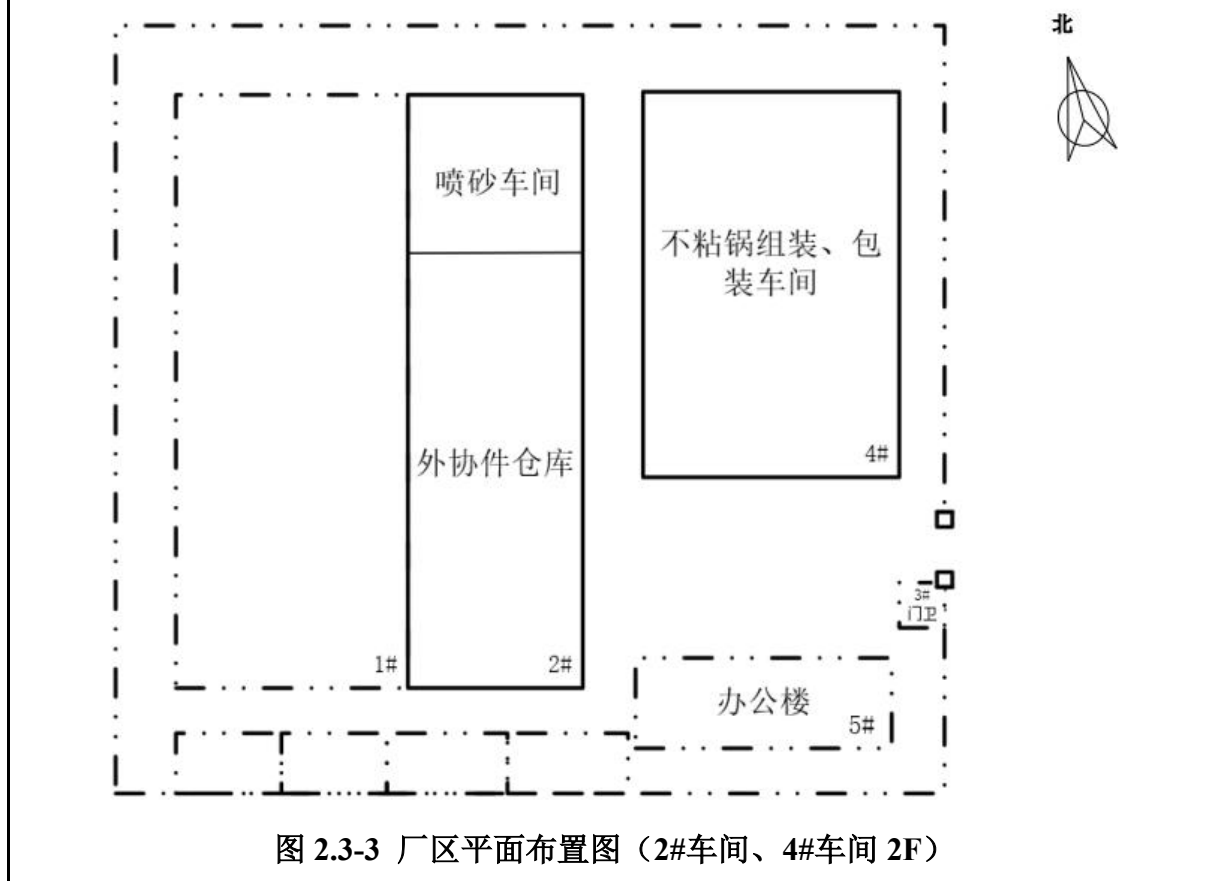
厂区平面布置图（2#车间、4#车间 2F）
